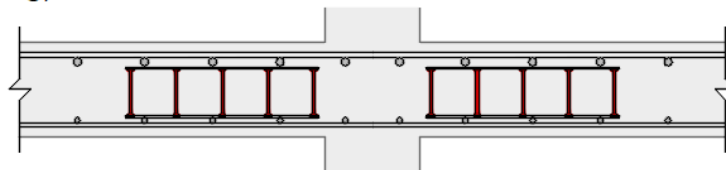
Tipos de armaduras de cisalhamento em lajes-lisas
